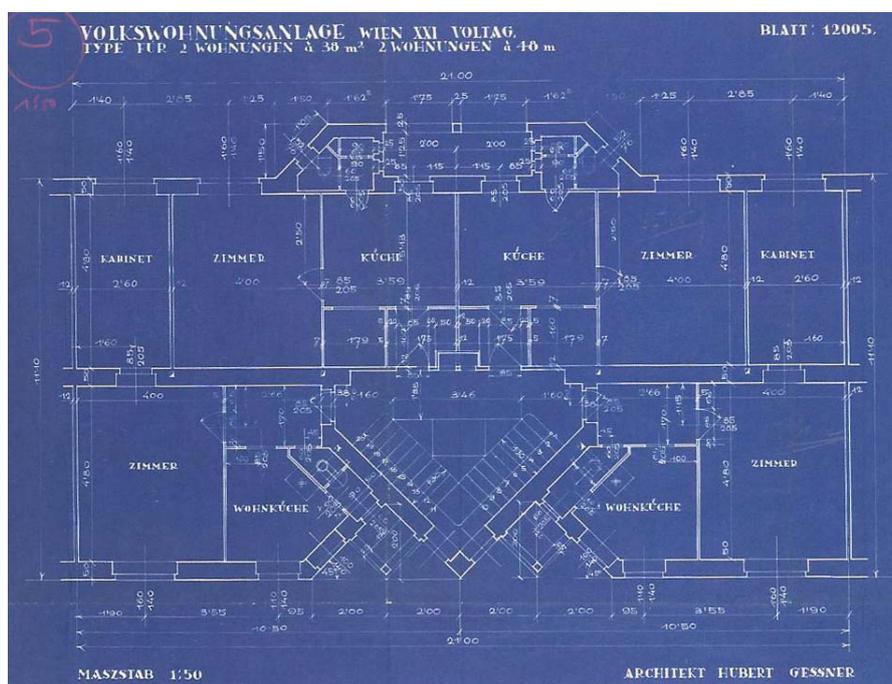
Karl-Seitz-Hof, Regelgeschoßgrundriss
